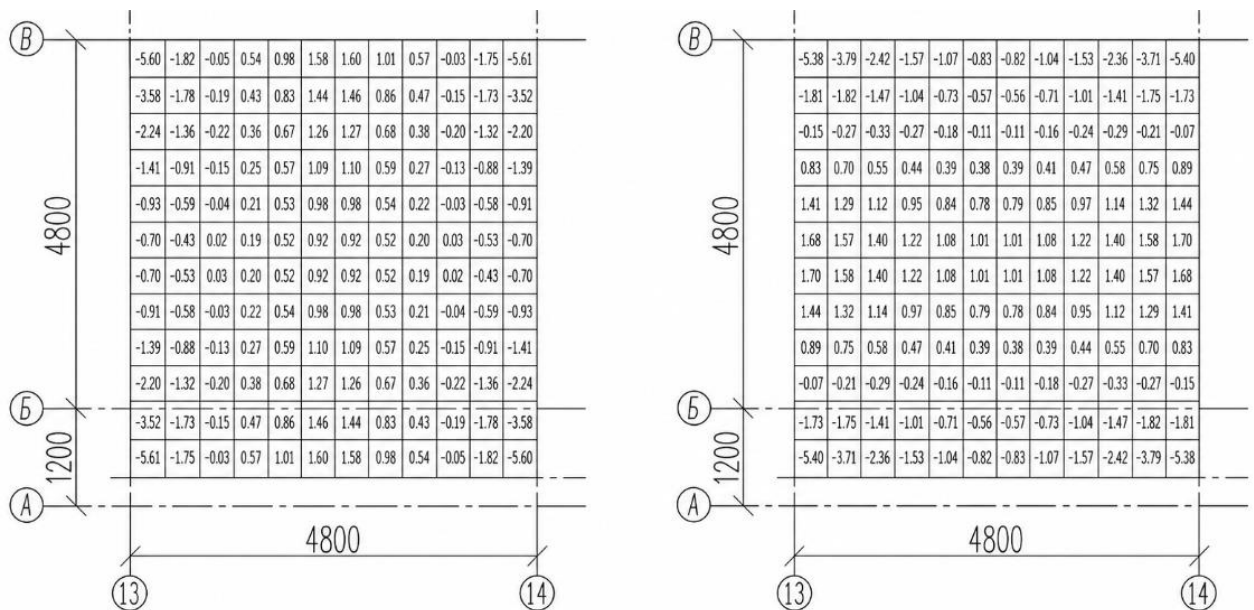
Ділянка перекриття типового поверху, моменти M_x та M_y
